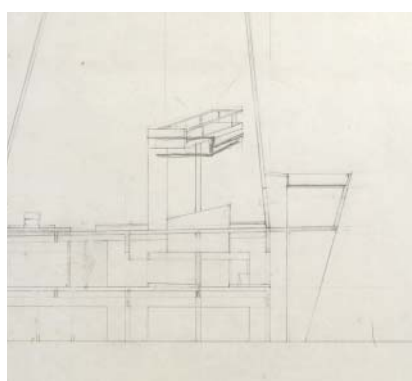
Dibujo en sección con el pilar en los niveles 1, 2 y 3. Fuente: FLC.16546
